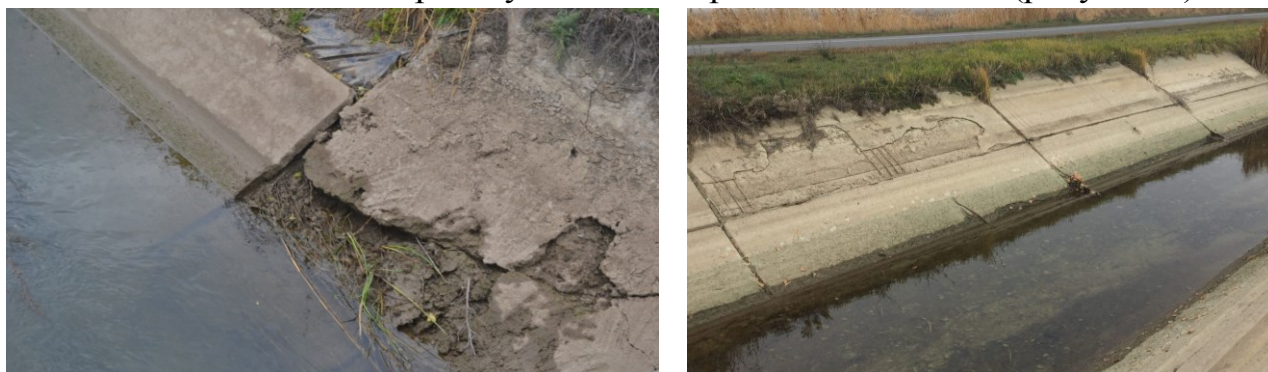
Дефекты поверхности бетонной облицовки канала в виде оголения арматуры, шелушения бетона и сколов
